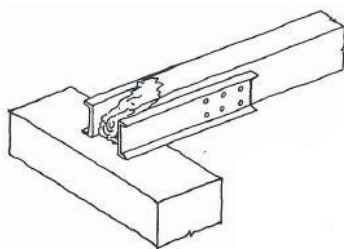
Representação esquemática da fixação de elementos metálicos à viga existente (adaptado de Arriaga, et al., 2002)
